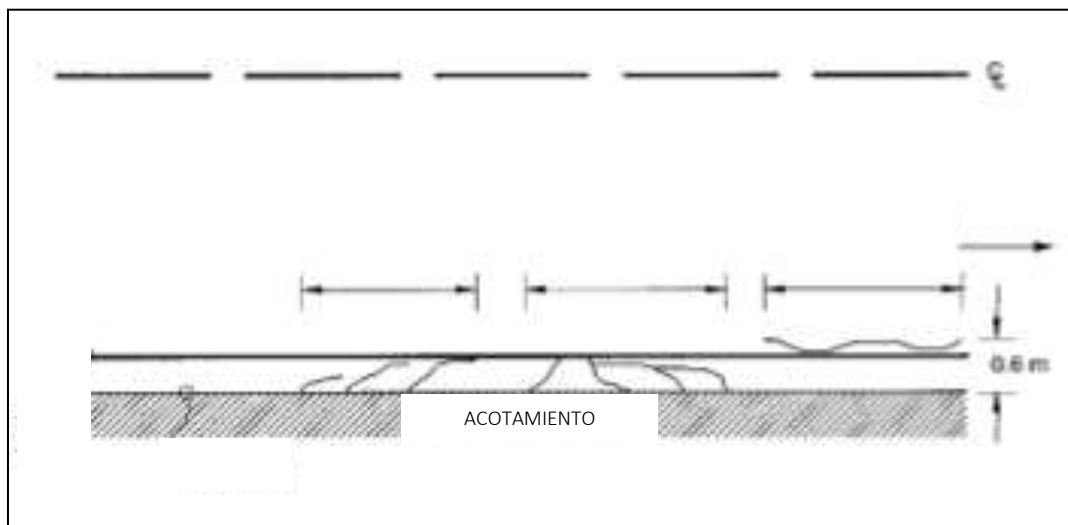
Grietas de borde. (FHWA, 2003)
